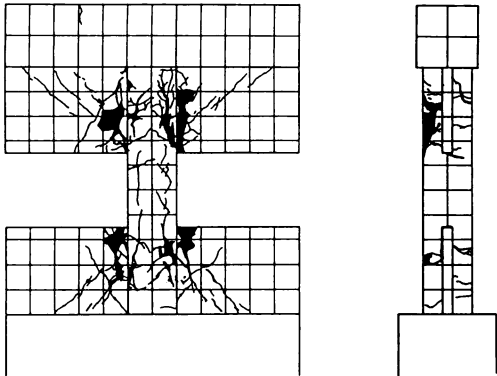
(e) 試験体 CSS05 の実験終了後のひび割れ図
